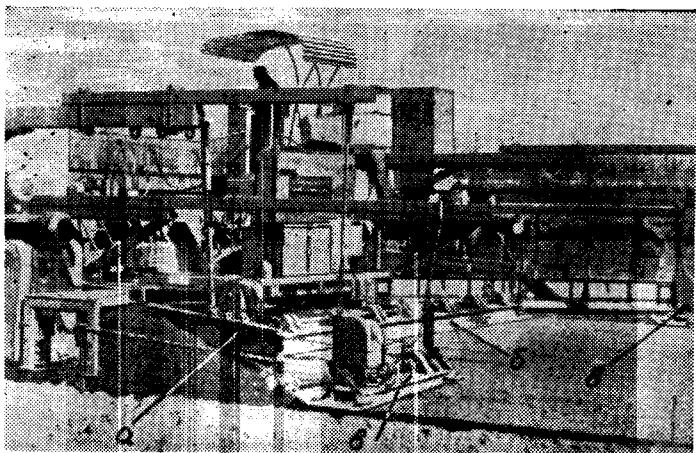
Бетоноукладчик с дополнительным сменным оборудованием для укладки гравийно-песчаного основания:
